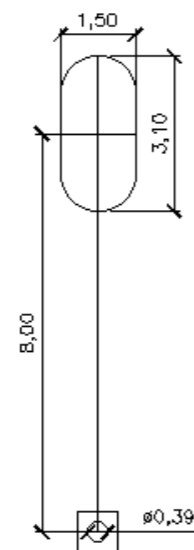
Vista en planta de una sección tubular de una torre con su correspondiente retenida. Fuente: Elaboración propia.
